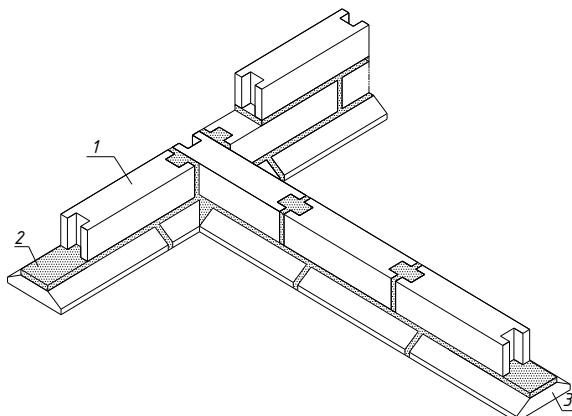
Вариант сборного ленточного фундамента: 1-фундаментный блок, ФБС; 2-цементно-песчаный раствор; 3-фундаментная подушка, ФЛ
